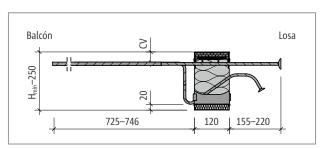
Schöck Isokorb® XT tipo K-U-M2: Sección del producto
